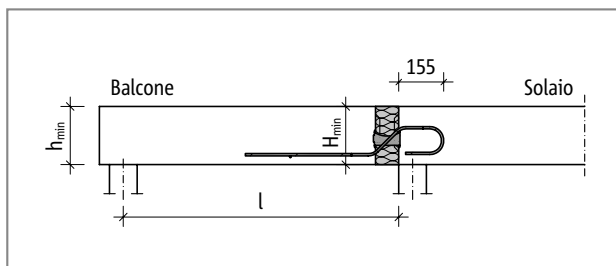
Schöck Isokorb® tipo da Q10S a Q30S: schema statico
